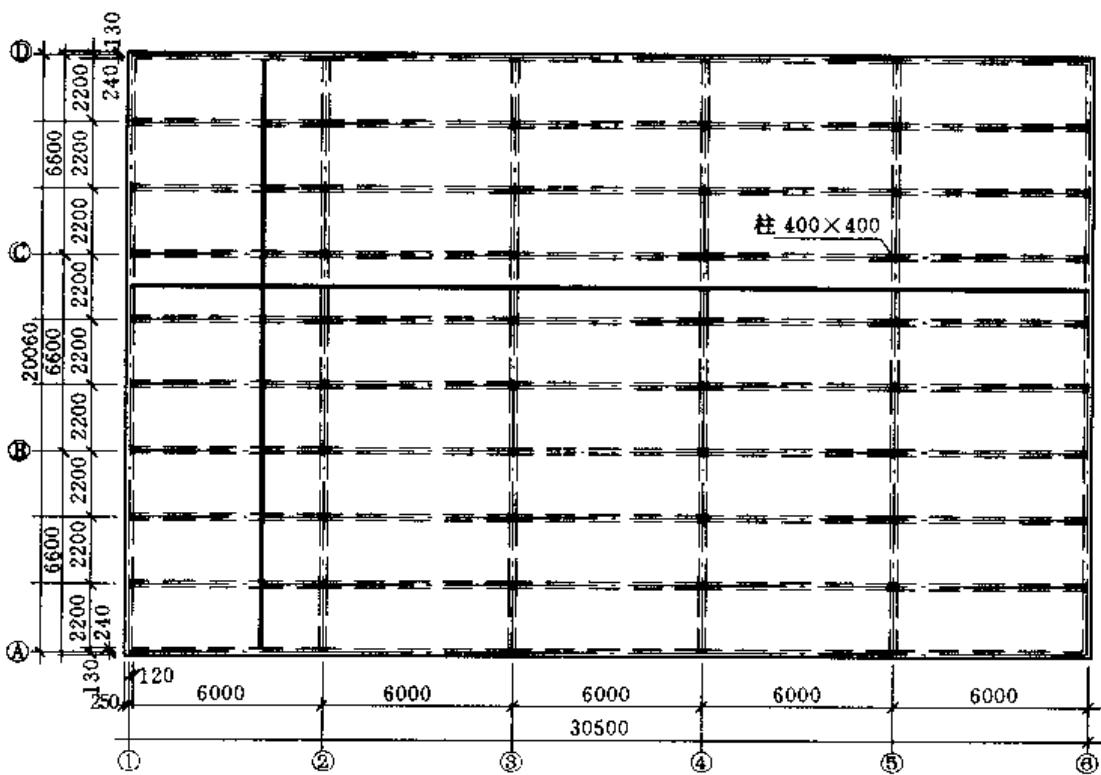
楼盖结构平面布置图 (单位: mm)
